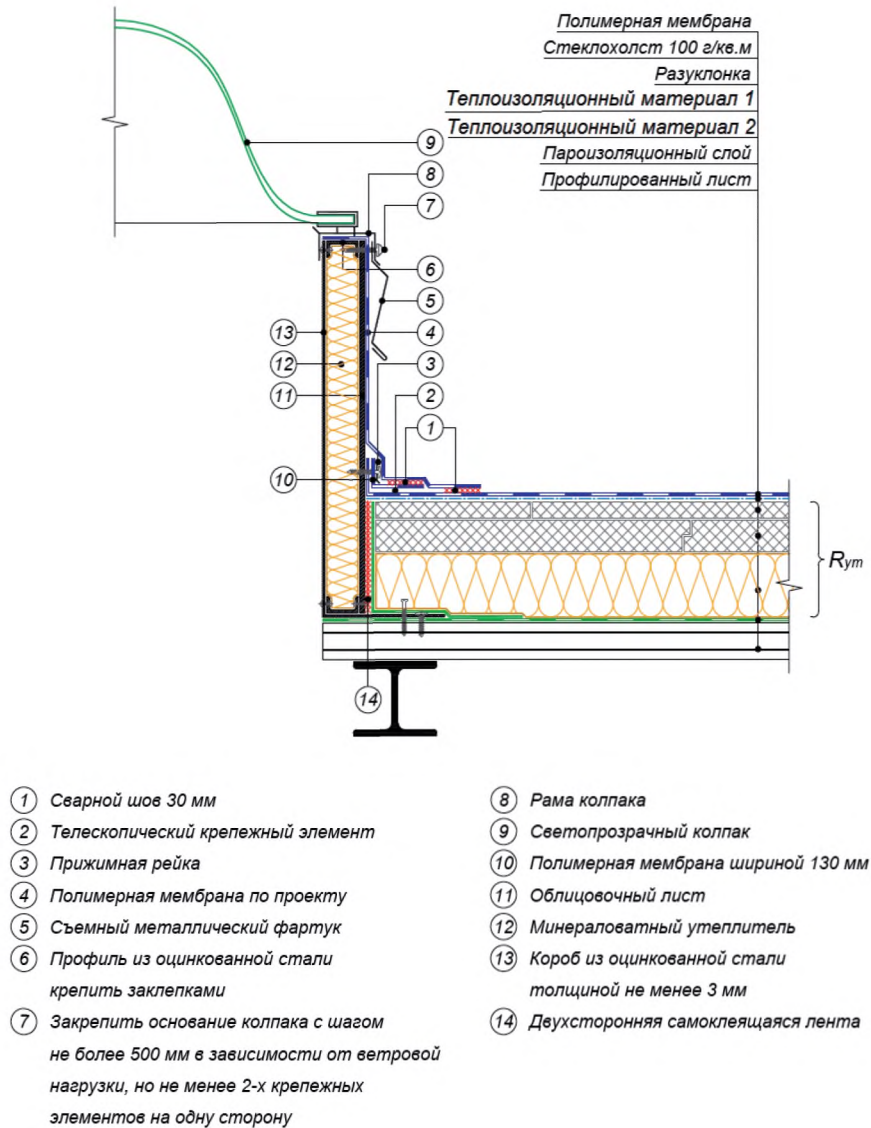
Схема установки фонаря для совмещенного кровельного покрытия с основанием из профилированного листа
